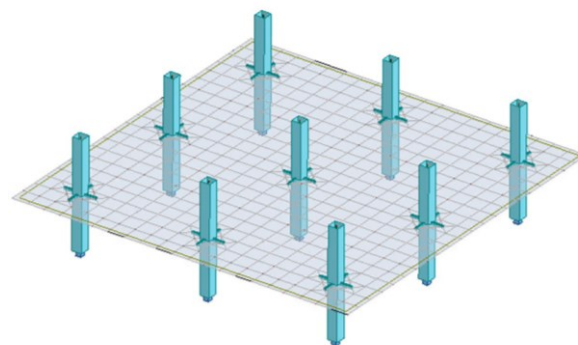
Расчетная схема перекрытия с балочными срезными узлами в расчетном комплексе Robot structural
